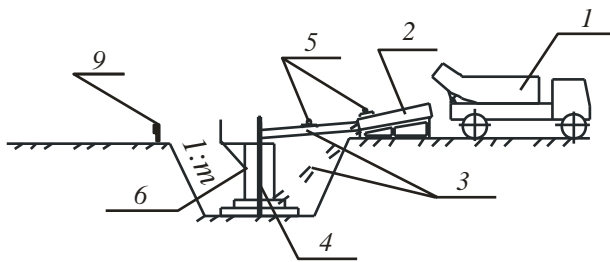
Схема бетонирования фундаментов при помощи вибропитателя и виброжелоба:
